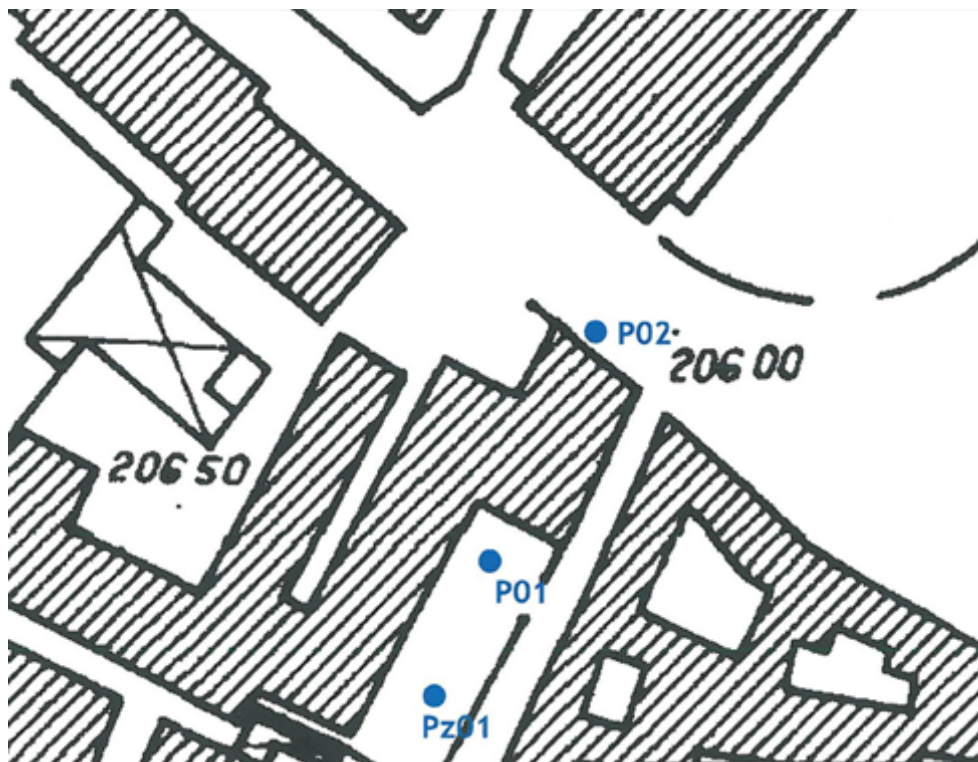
Posizione dei sondaggi presso l'Archivio di Stato in Pallanza v. Luigi Cadorna
